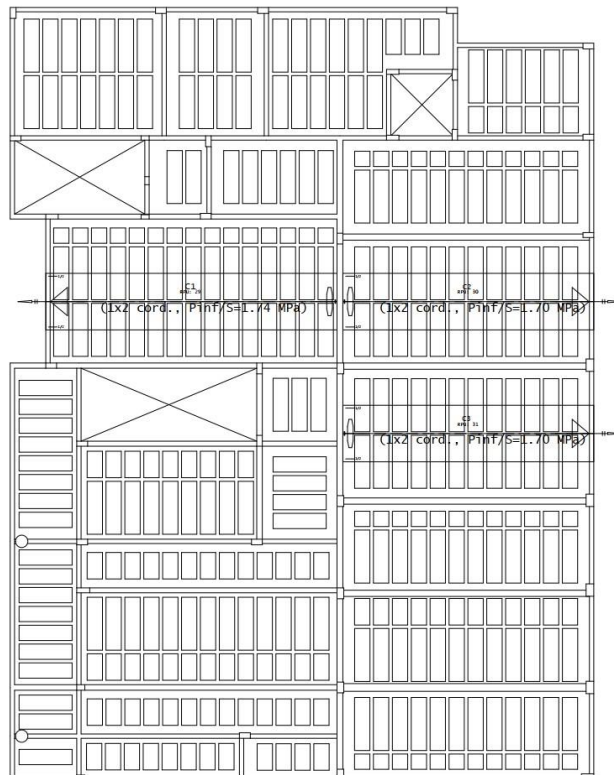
Traçado de RPU horizontais e distribuição de cabos do sistema de laje nervurada unidirecional protendida no TQS. (Fonte: Autoria própria; 2023)
